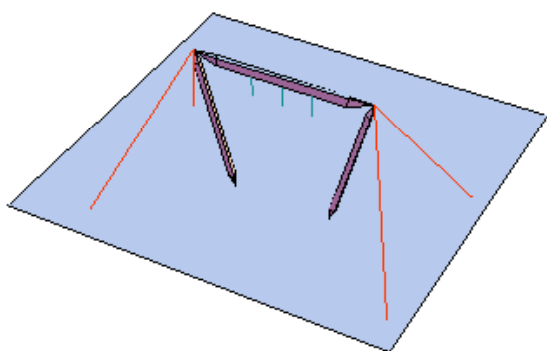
Vista tridimensional esquemática da estrutura do exemplo da Fig. 11.
